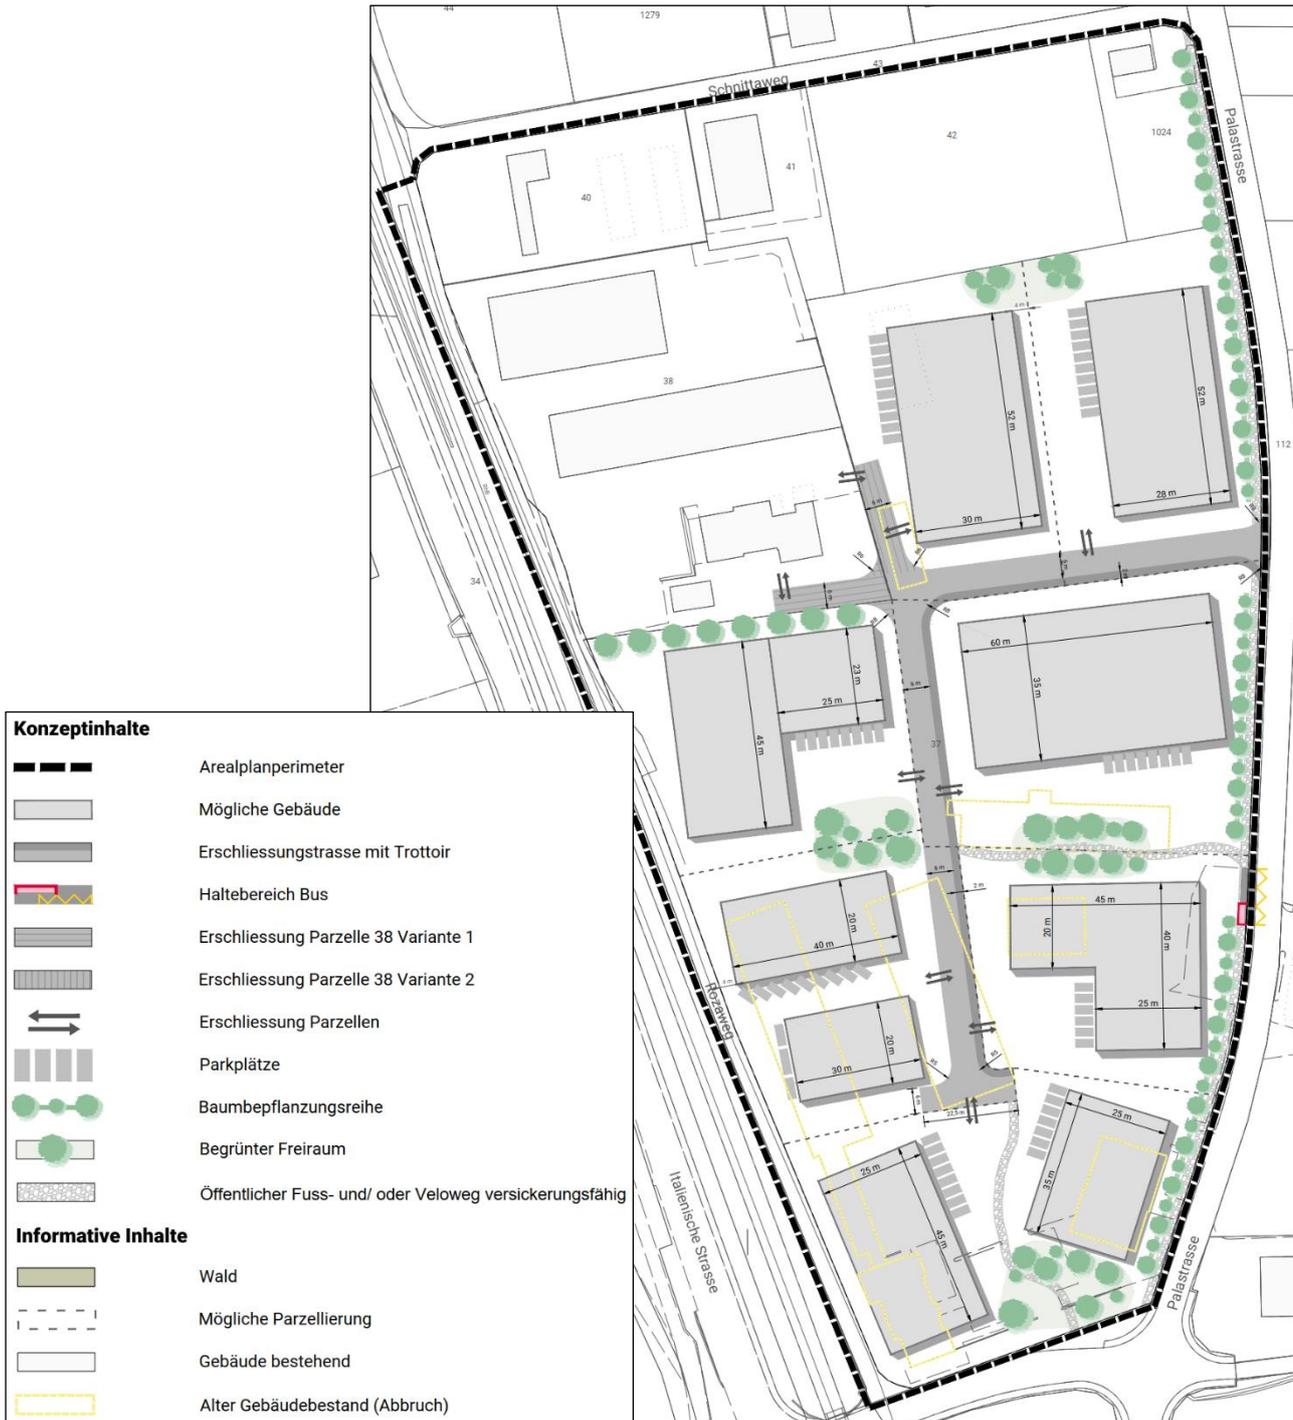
Konzeptplan Arealplan Roza, Darstellung R+K
